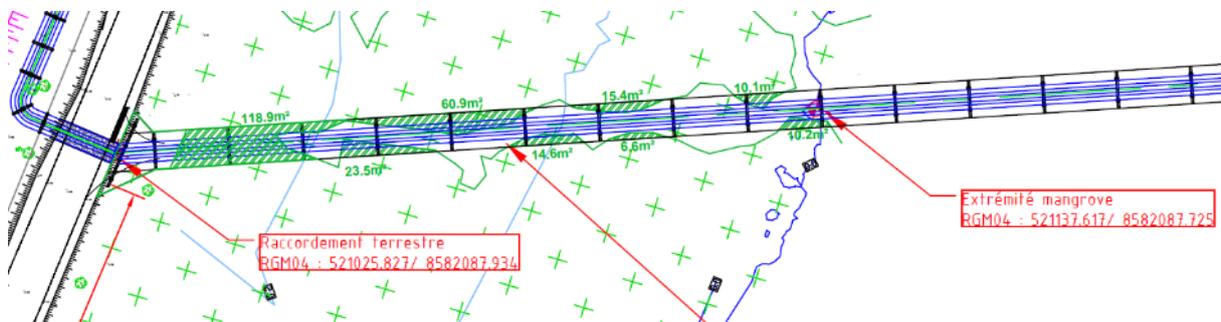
zone de palétuviers & emprise de la passerelle sur une longueur de 112 mètres
